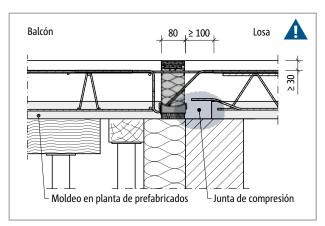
Schöck Isokorb® T tipo K/K-F: apoyo directo, instalación conjuntamente con placas prefabricadas (aquí: h ≤ 170 mm), junta de compresión del lado de la losa
